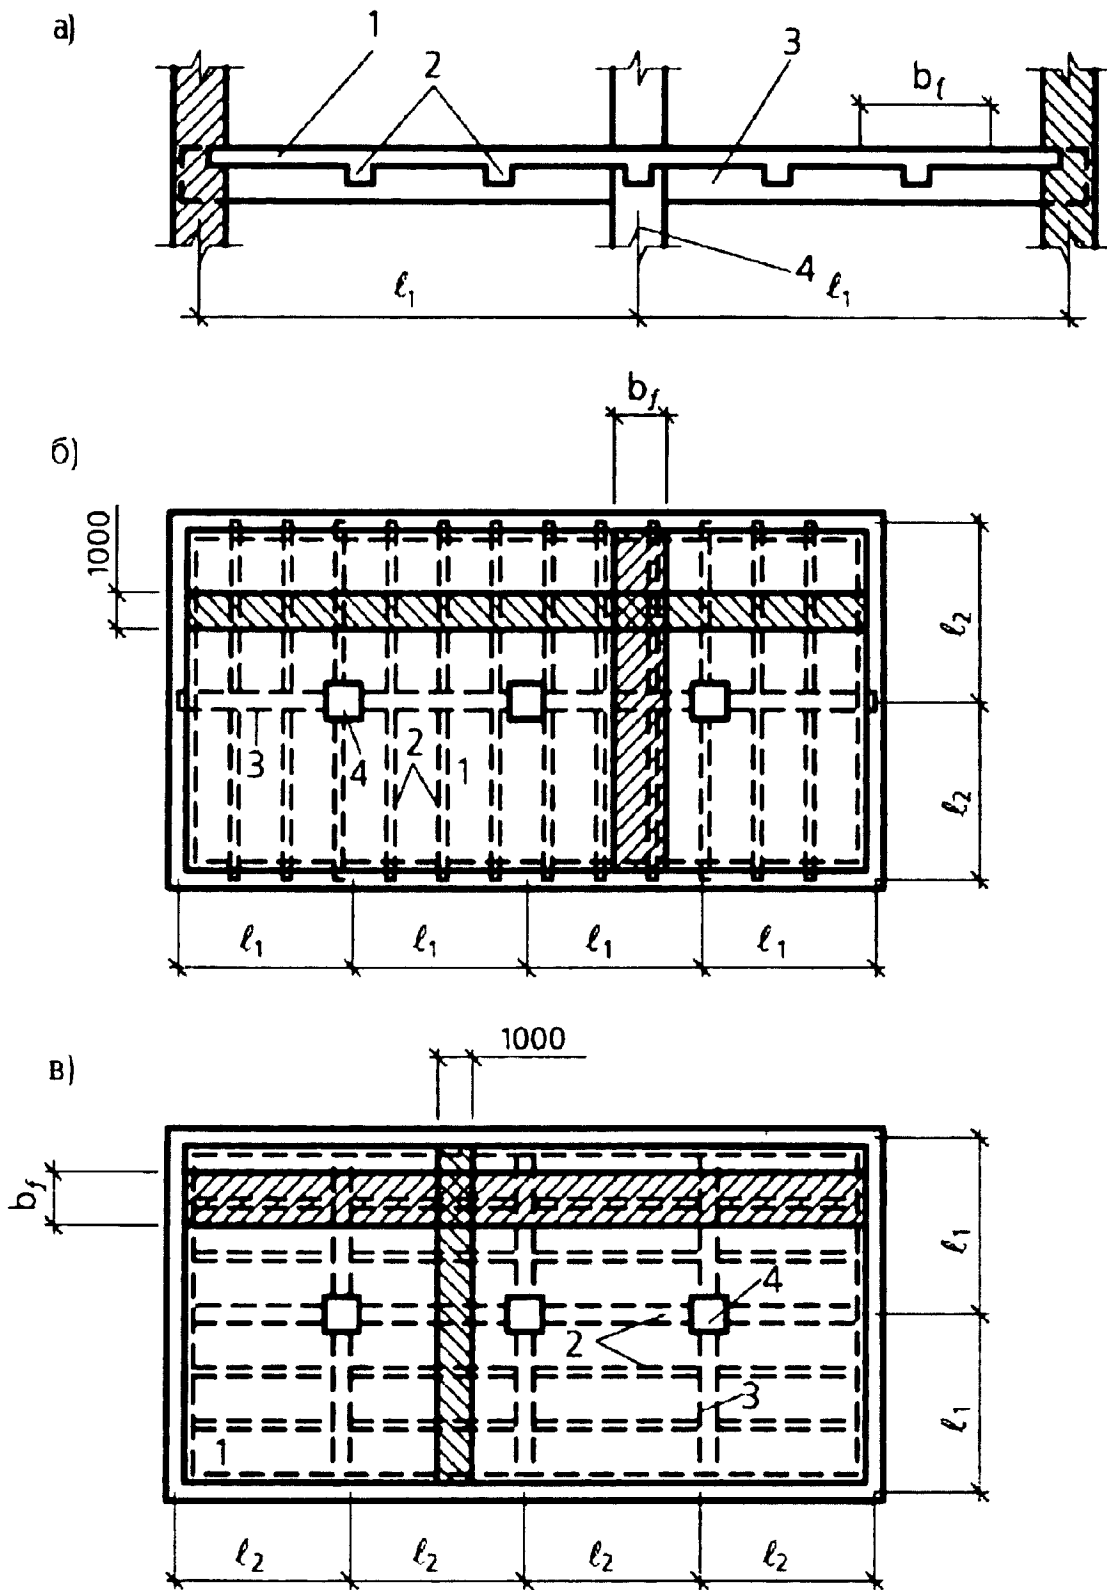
Конструктивные схемы монолитных ребристых перекрытий с балочными плитами: 1 - плита; 2 - второстепенная балка; 3 - главная балка; 4 - колонна
